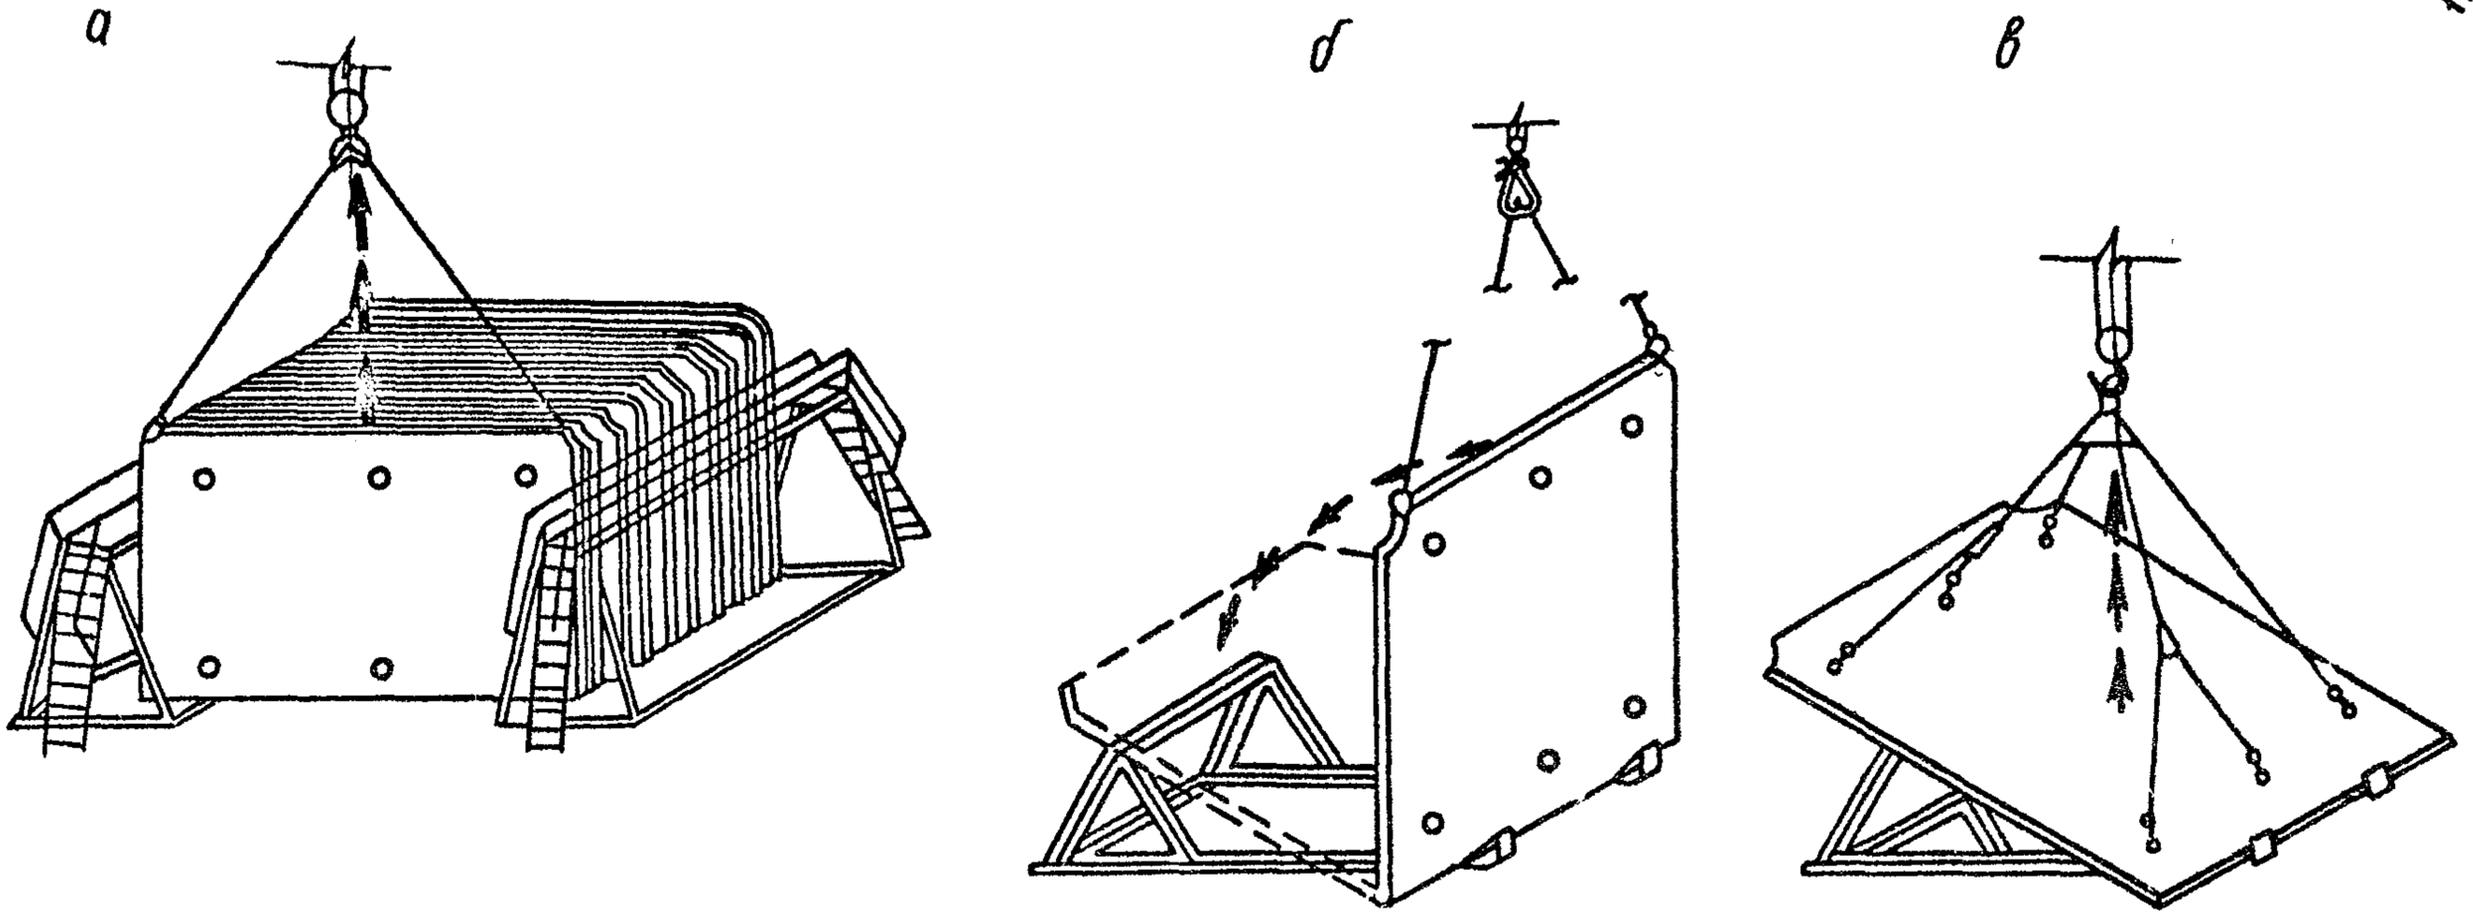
Последовательность перестропки панелей перекрытия: а-подъем панели перекрытия из кассеты; б-кантование панели перекрытия; в-перестропка
